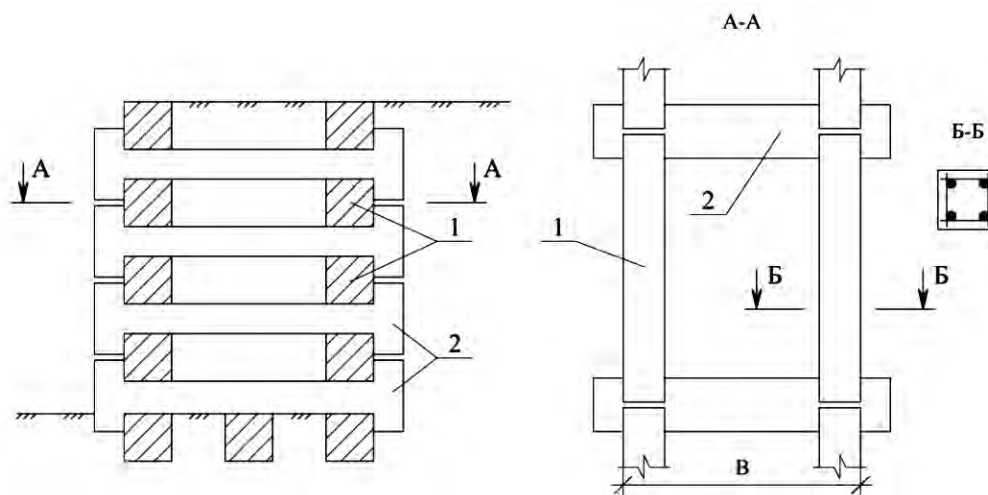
Железобетонная ряжевая стена: 1 – брус; 2 – анкерные балки
